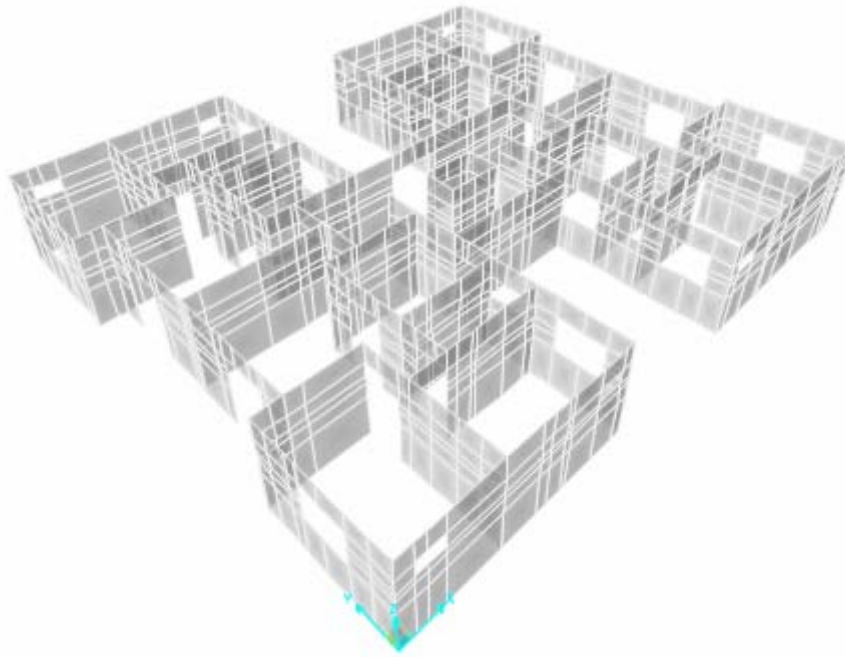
Paredes do primeiro pavimento com suas aberturas.
